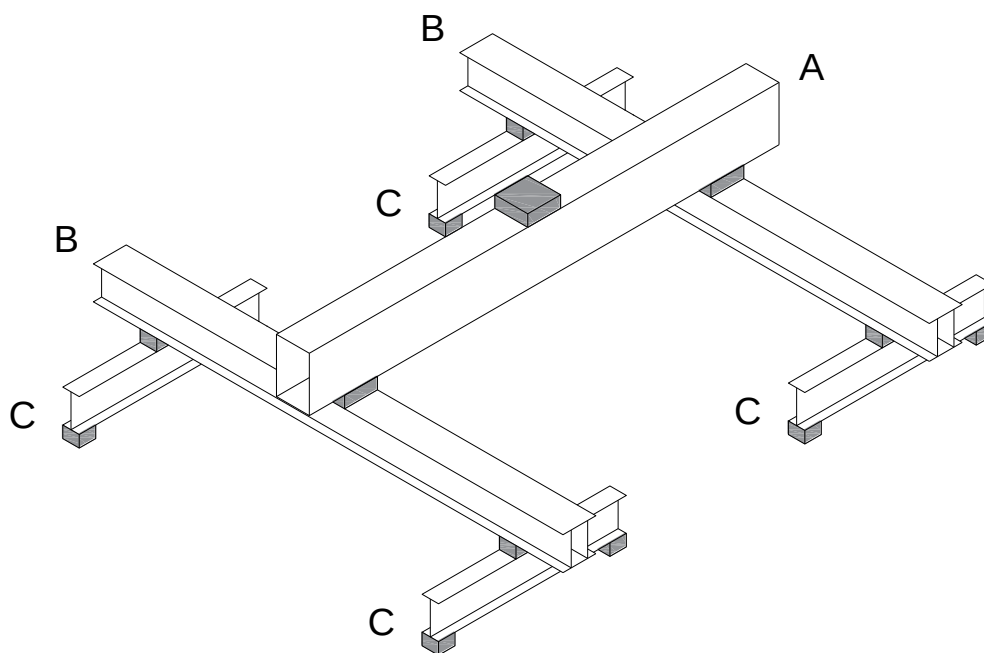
Rappresentazione 3D della struttura di carico fuori piano. Gli elementi campiti in grigio rappresentano connessioni a bassa rigidità flessionale (cerniere plastiche).
